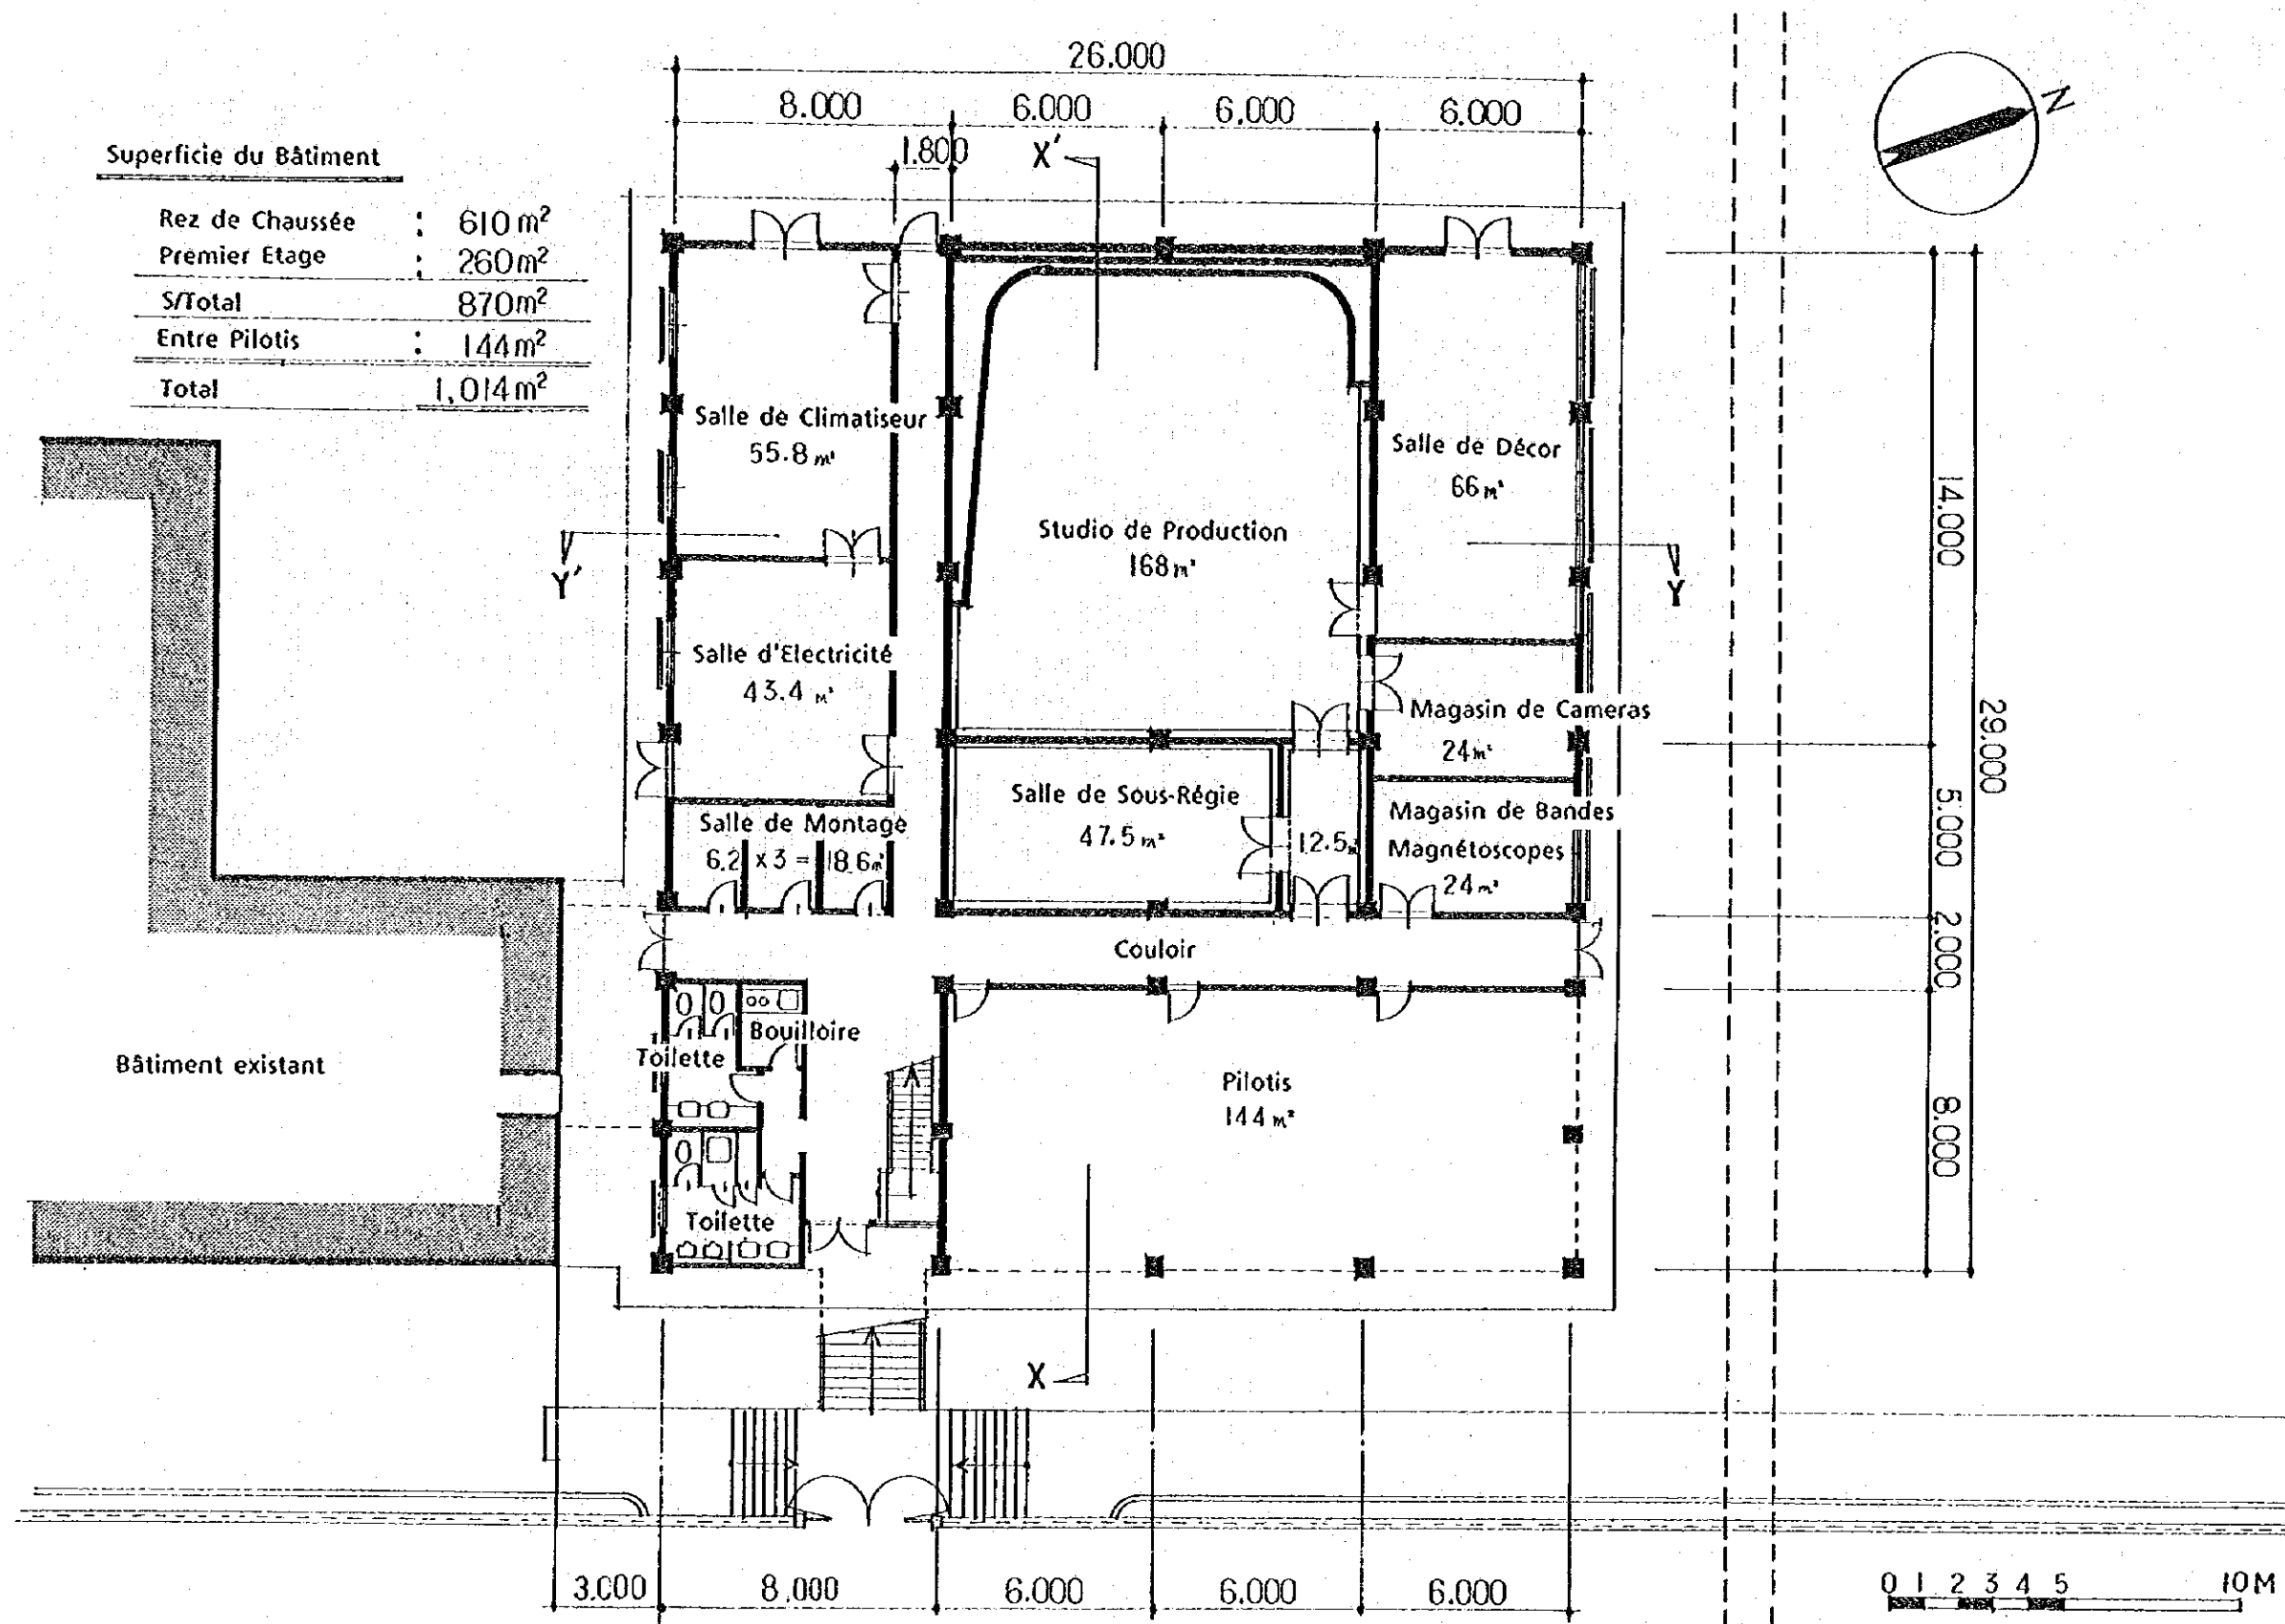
PLAN DU CENTRE DE LA TELEVISION (REZ DE CHAUSSEE)
